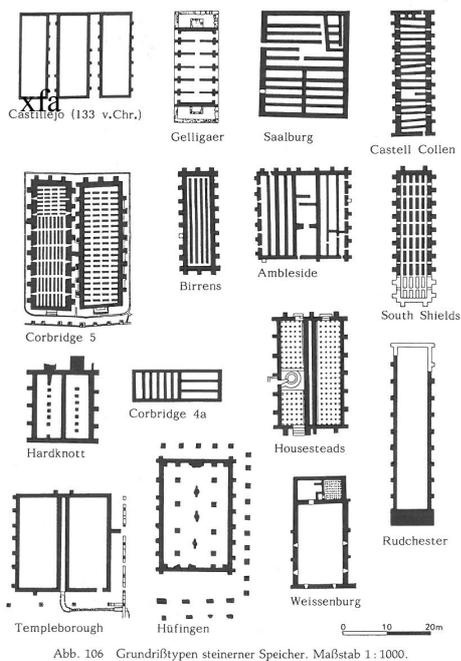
Grundrissstypen steinerne Speicher. Maßstab 1:1000.
